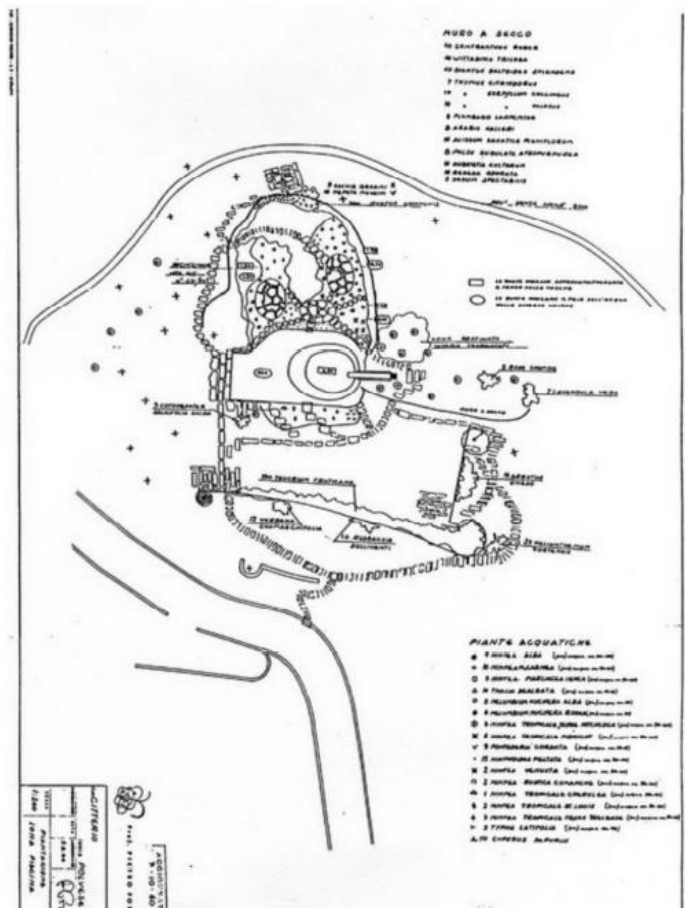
Planimetria originale del progetto Porcinai della piscina dei Conti Citterio (1960).
